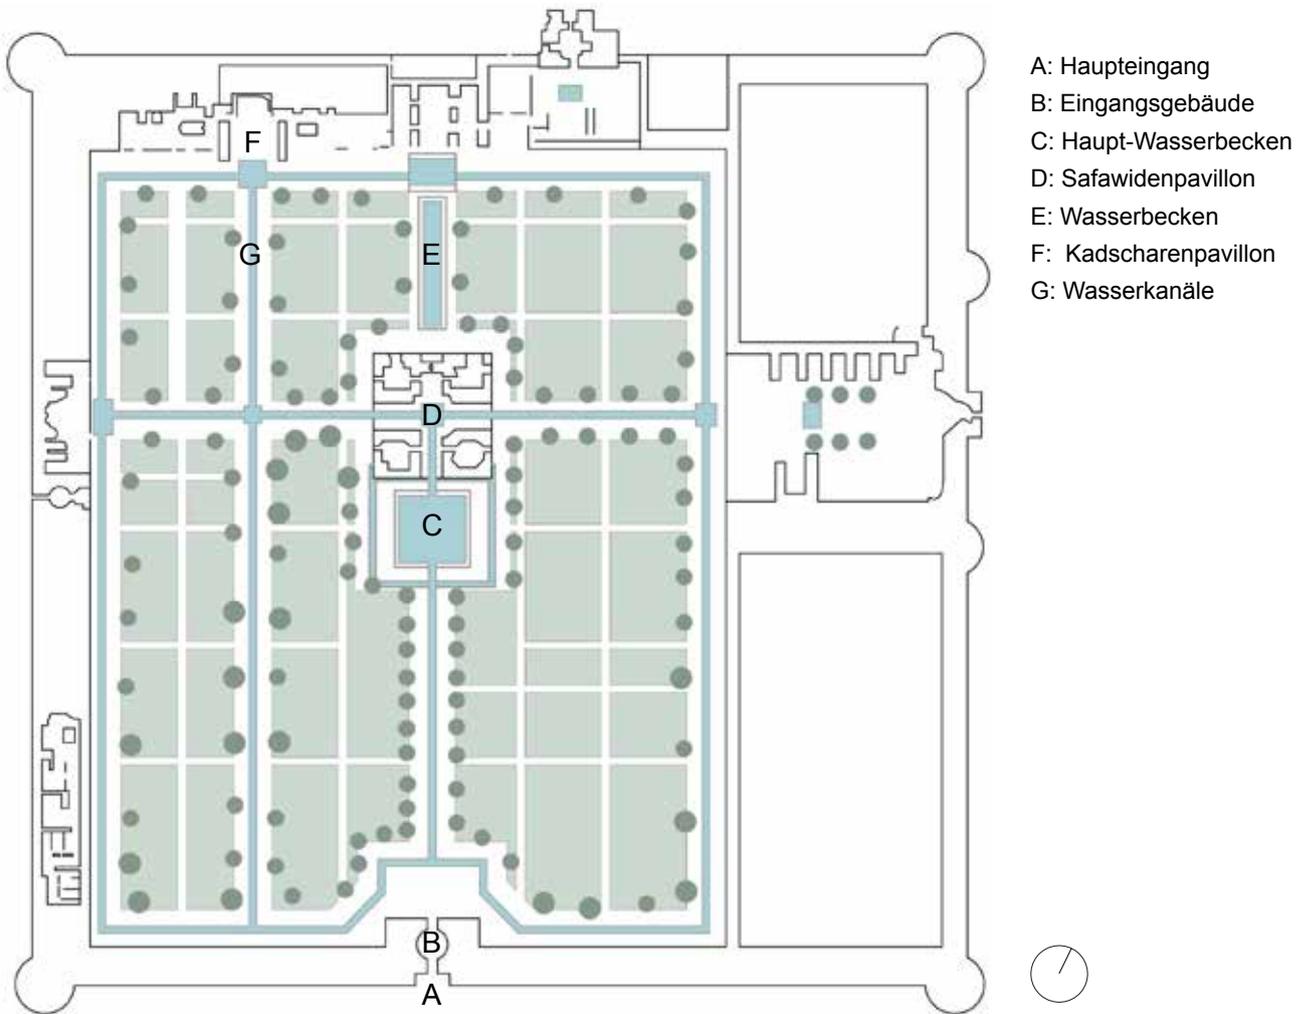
Grundriss Fin-Garten in Kaschan.
